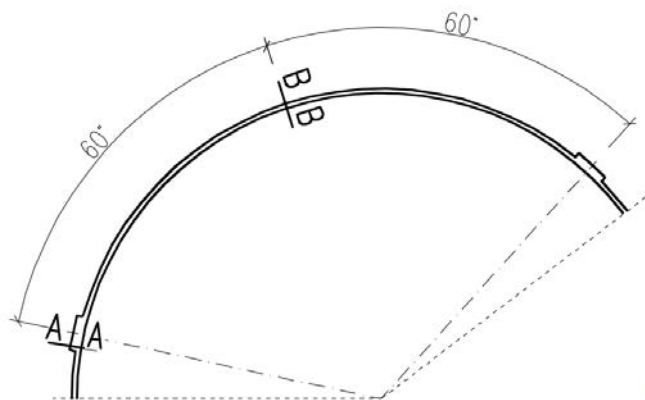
Widok modelu zbiornika z 6 pilastrami.
